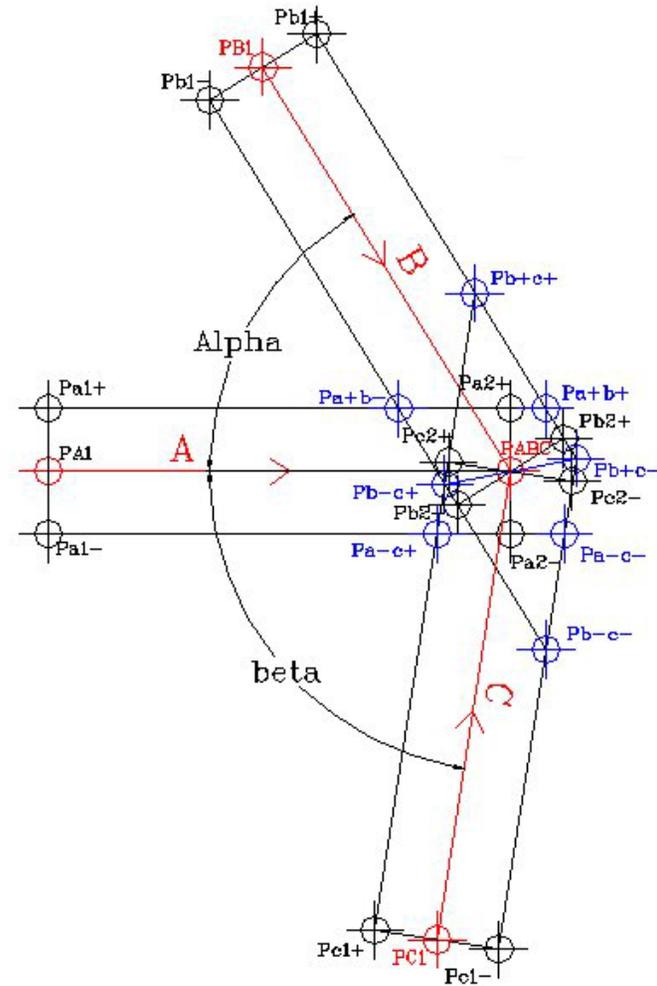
Exemple d'un assemblage de 3 pièces. 8 points sont calculés et les extrémités des pièces A, B et C sont modifiées en conséquence.
